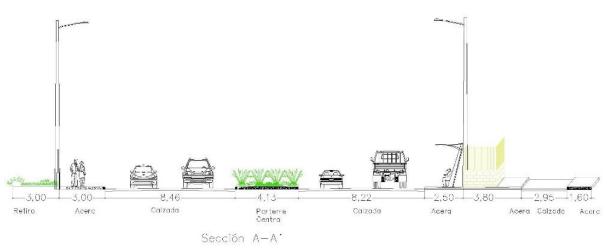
Sección de la intersección de las calles Juan Montalvo y la Calle Pichincha
